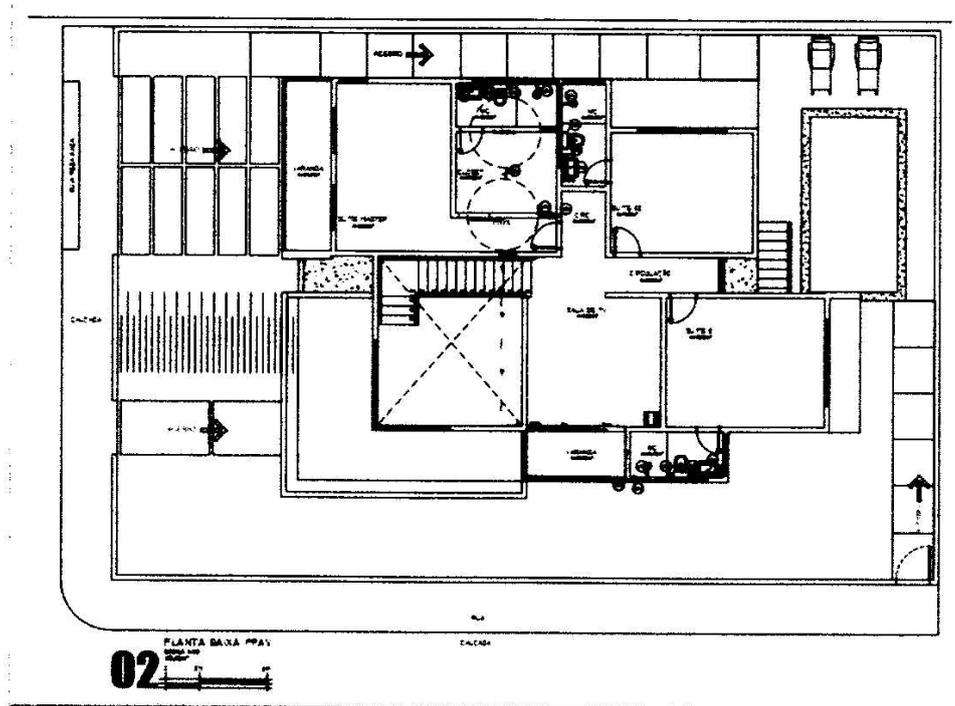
Planta baixa 1º Pav. Instalação predial de água fria.
